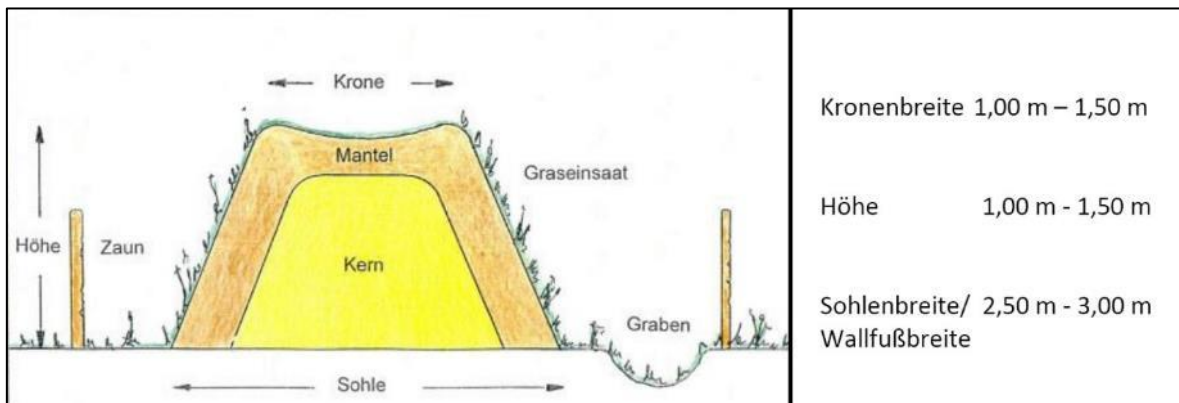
Aufbau des Walkkörpers und Pflanzschema
